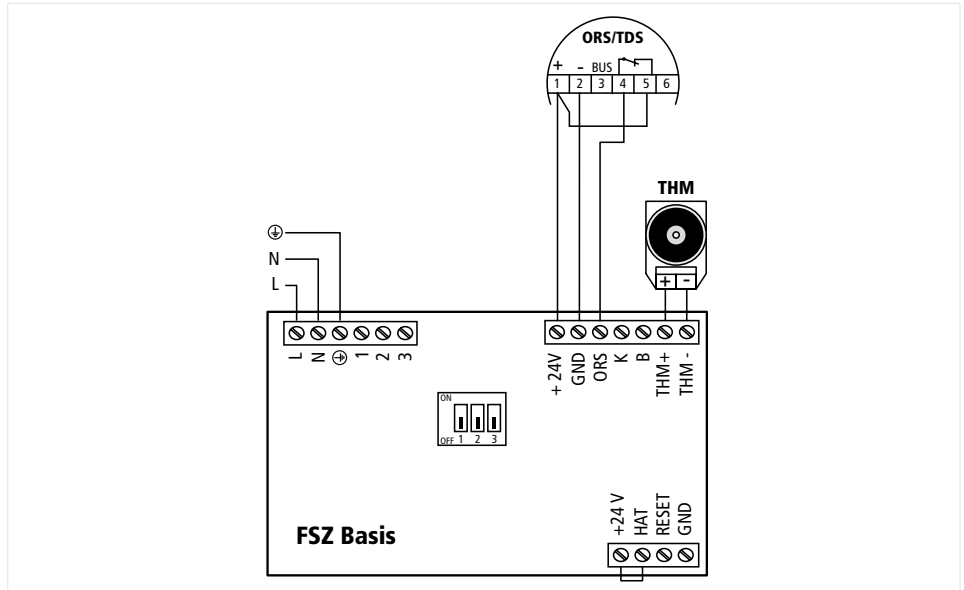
Installation mit 1 Brandmelder und 1 Feststellvorrichtung
